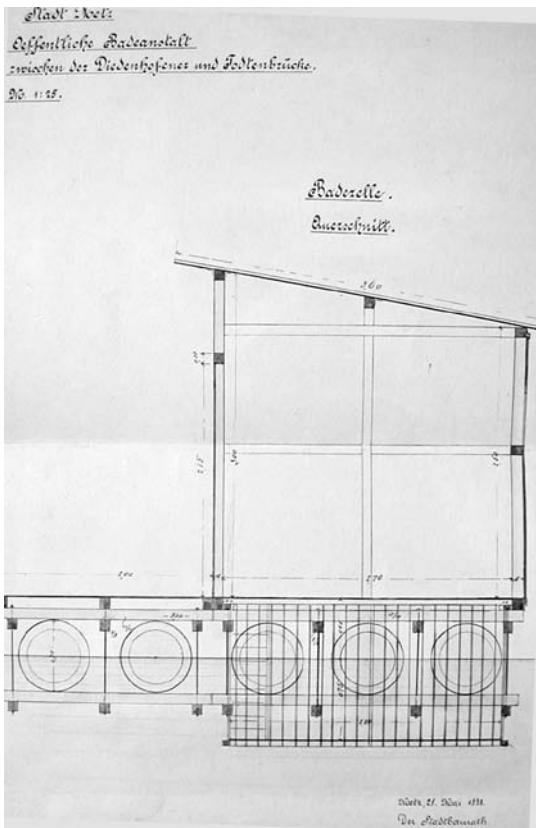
plan du site des bains de rivières entre le pont de Thionville et le pont des Morts,
